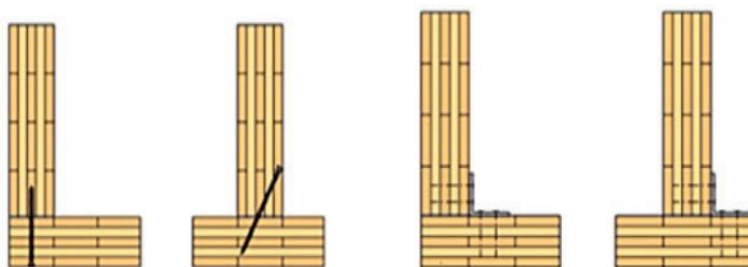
Угловое и Т-образное соединение стеновых панелей
